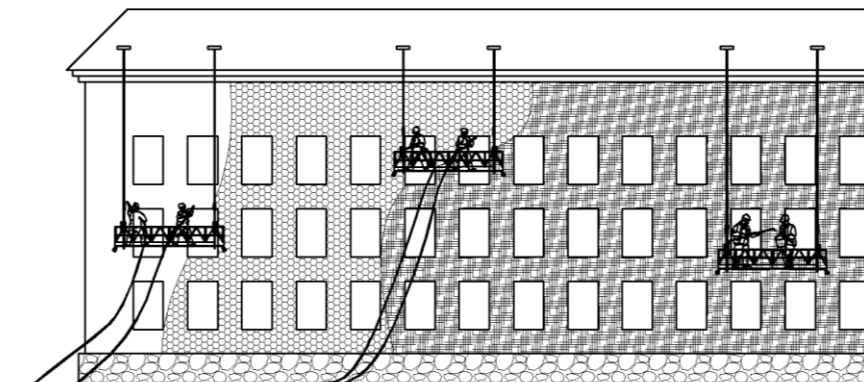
Технологическая схема производства работ по утеплению стен с навесных люлек
